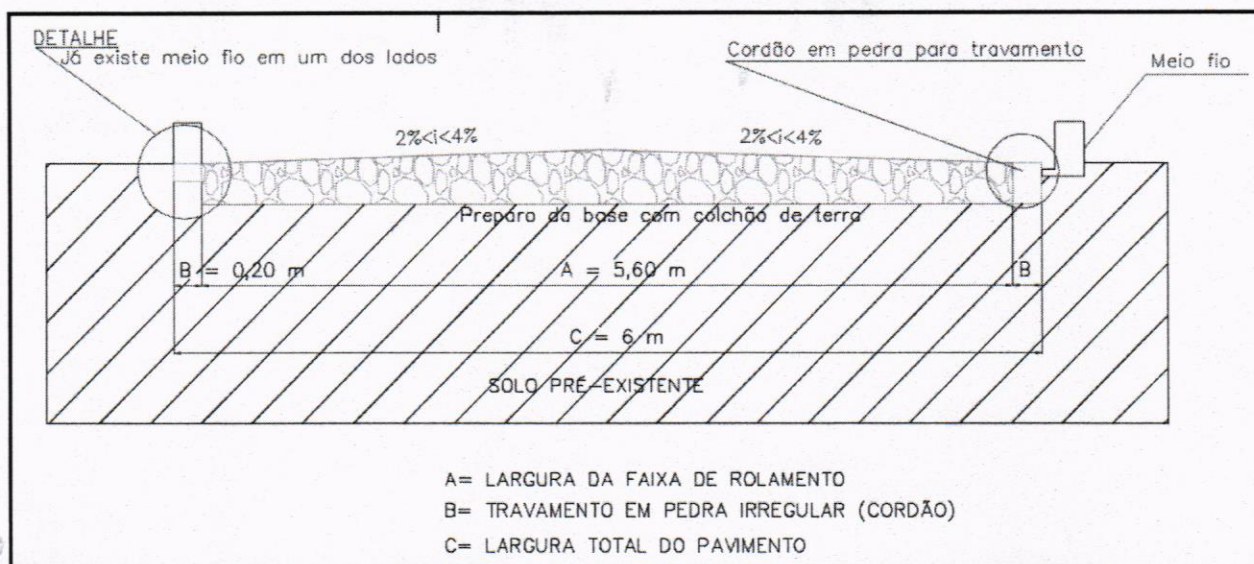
Detalhe em corte transversal do Pavimento - Genérico
